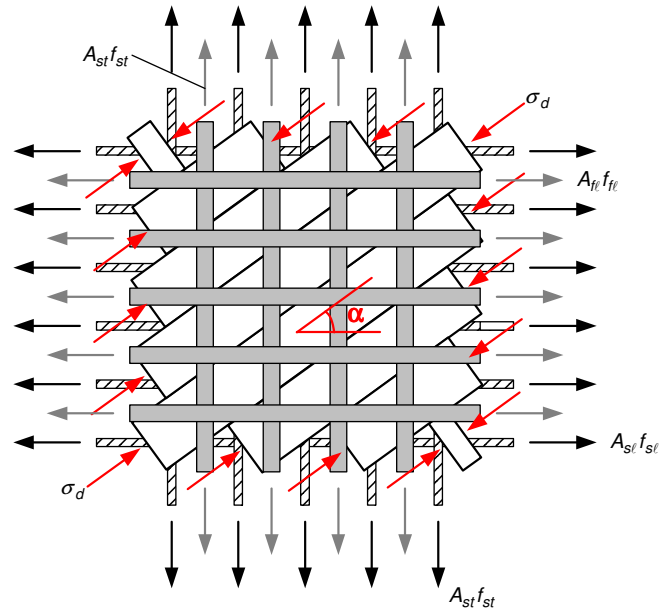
Painel fissurado de concreto armado reforçado com CFC.
